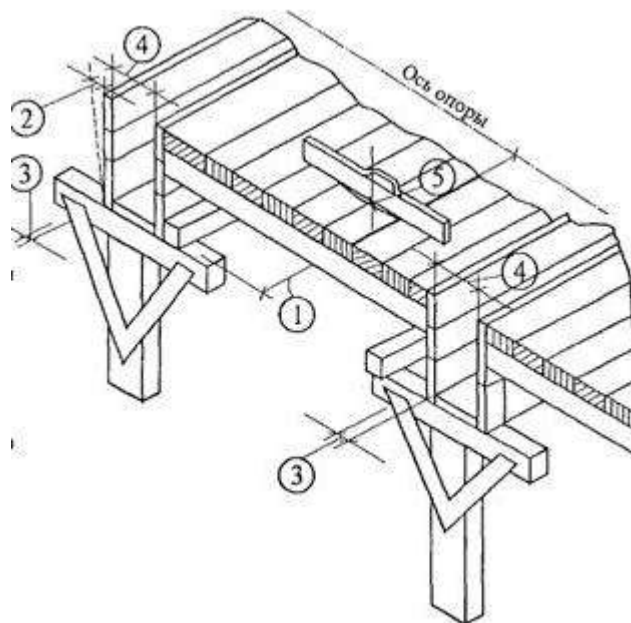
Схема предельные отклонения по опалубке перекрытия
